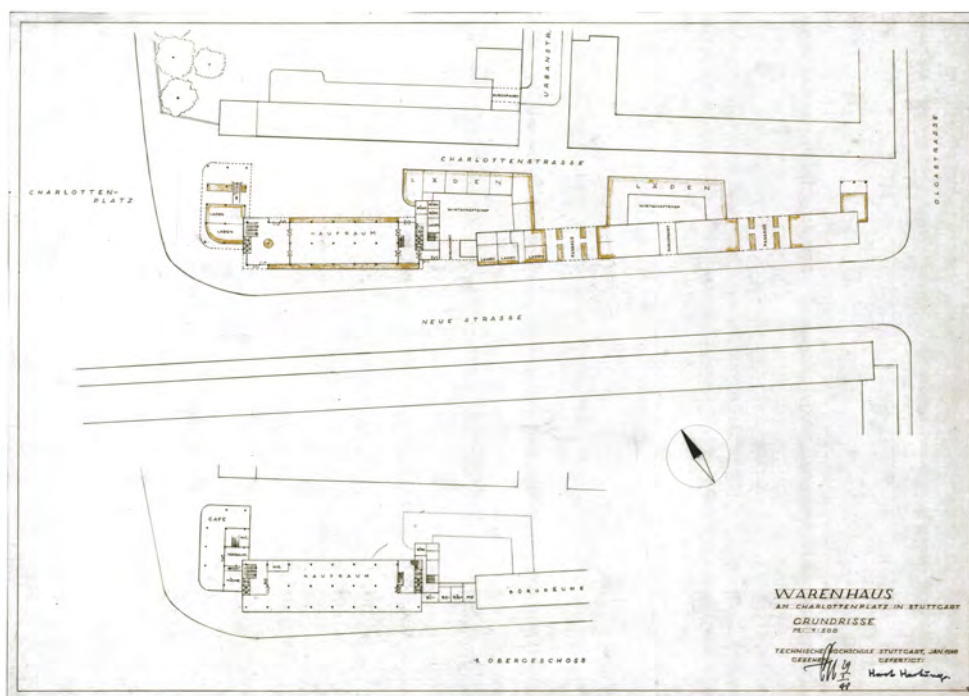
Fünfter Entwurf „Warenhaus“, Grundrisse Erdgeschoss und Obergeschoss
